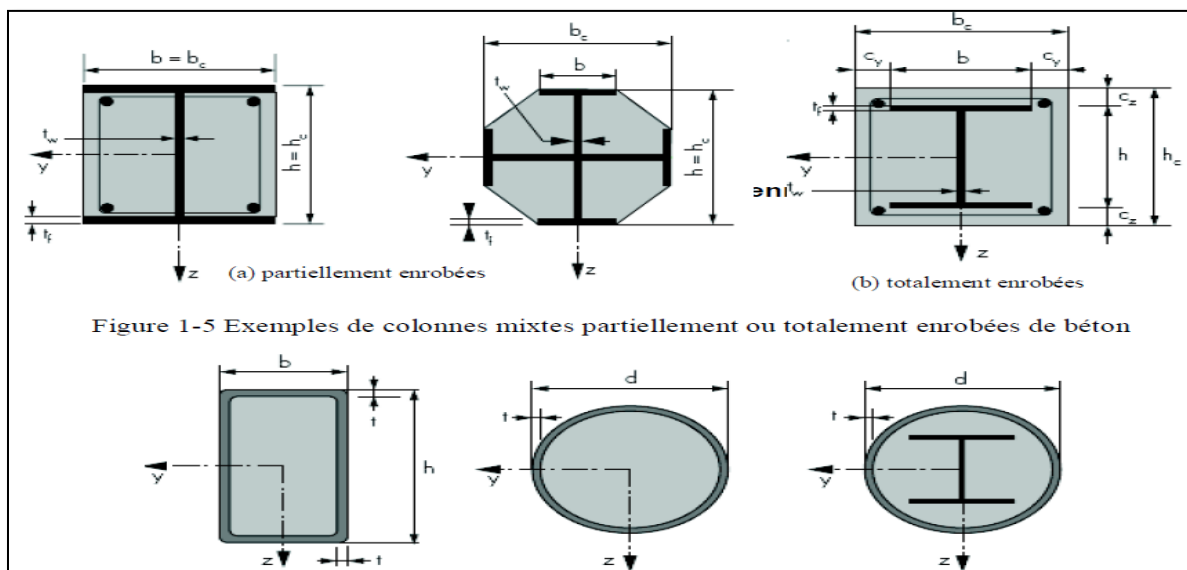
Exemples de colonnes mixtes partiellement ou totalement enrobées de béton
